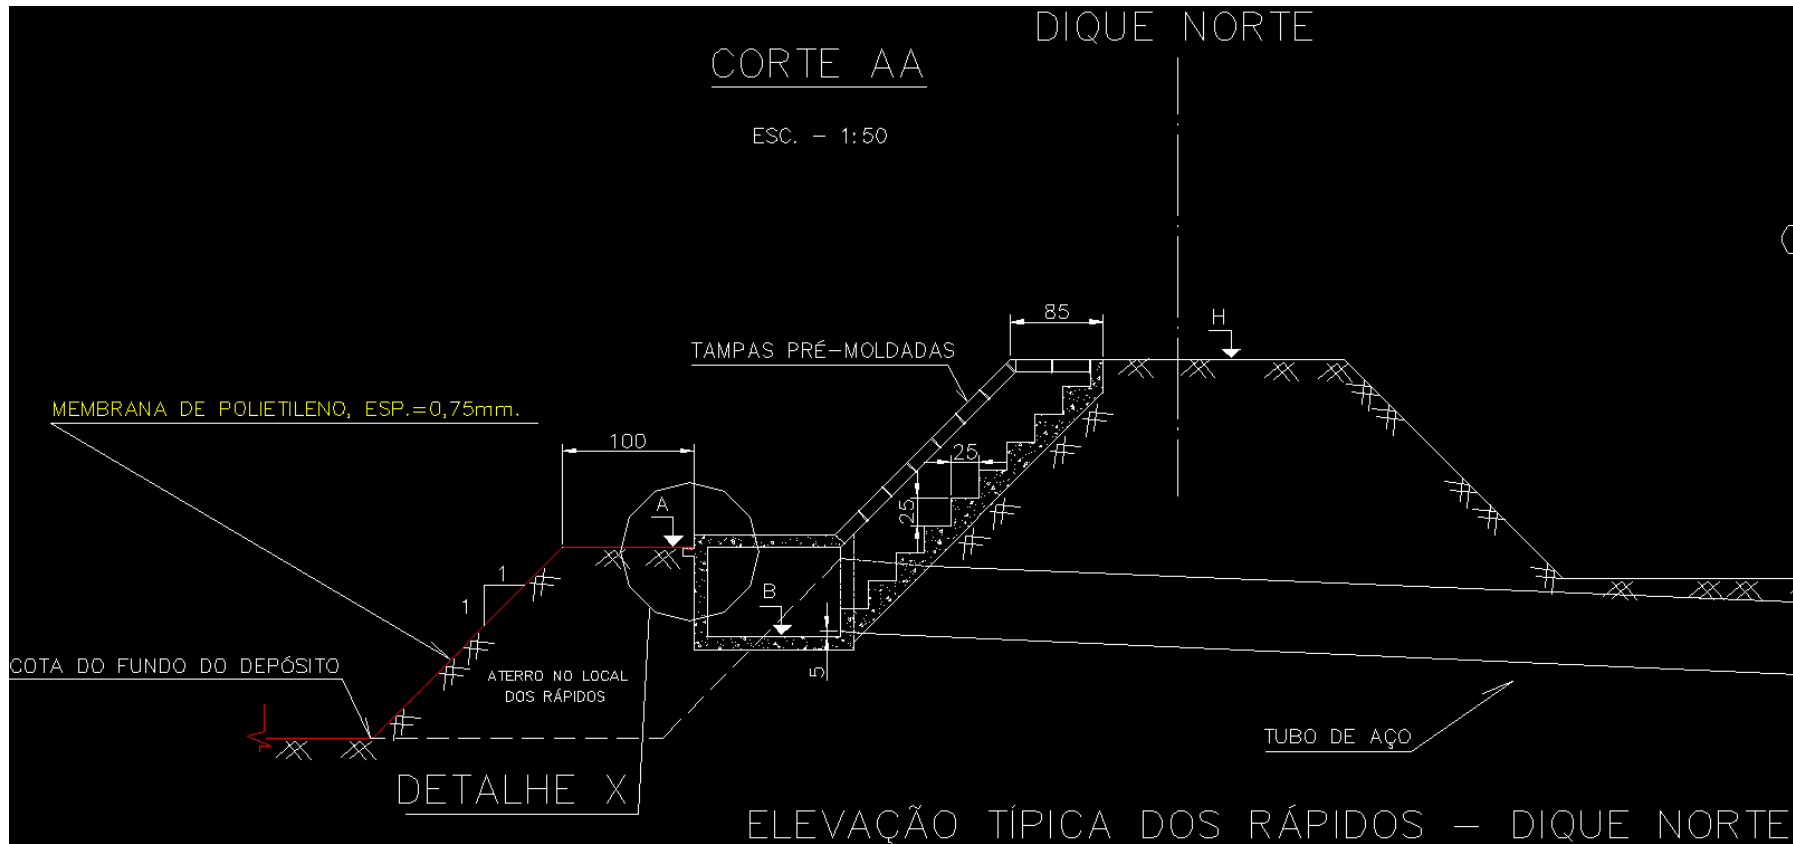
Planta e seções do projeto de drenagem da 3ª fase de expansão DRS1. (Adaptado de D1\_3000\_54\_G\_036\_00\_AREA 54A)
